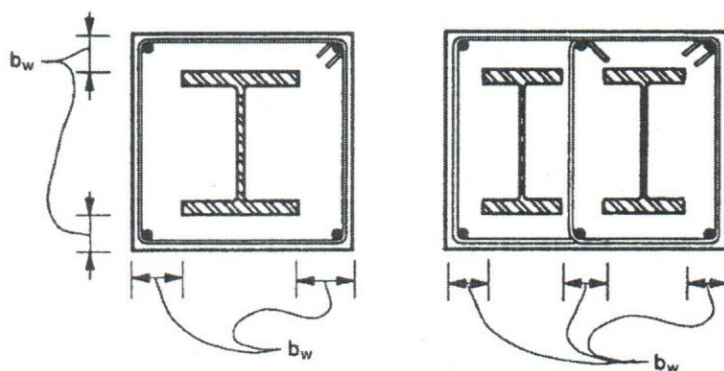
Anchura efectiva para el cálculo de corte en columnas mixtas embebidas¹⁹.
